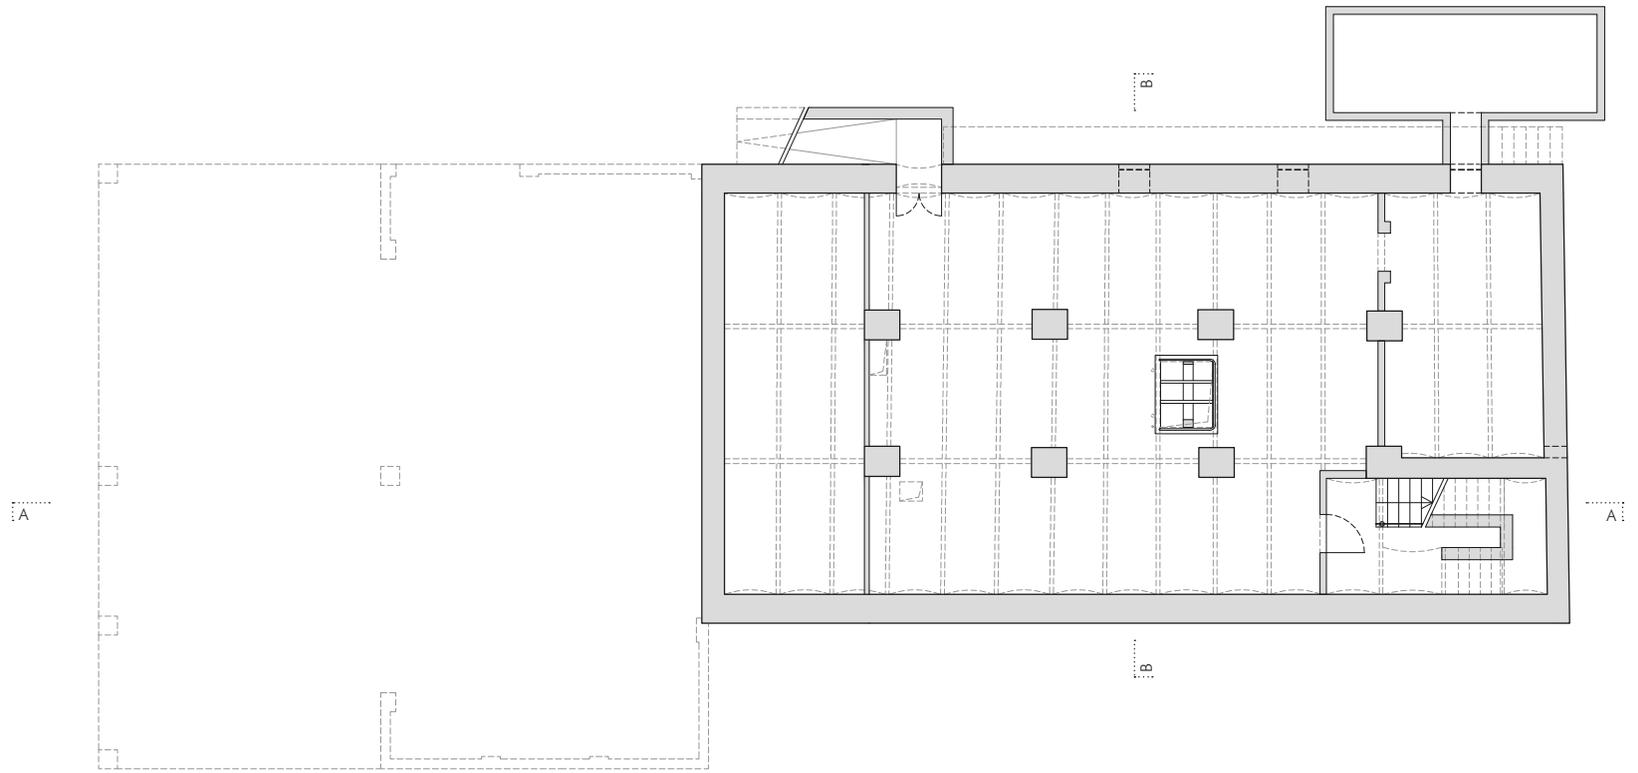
Grundriss Kellergeschoß, Bestand, M 1:200
